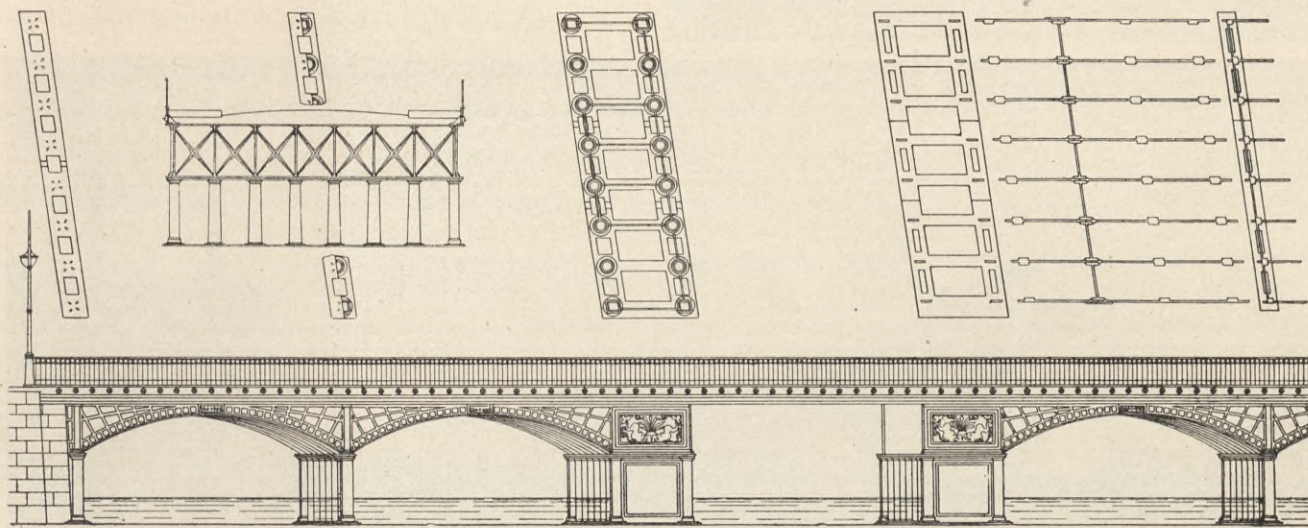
Ansicht der gusseisernen Weidendammer Brücke.
